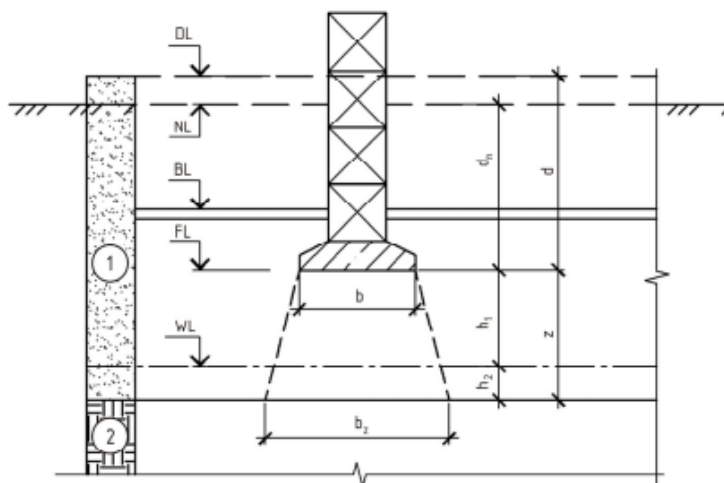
Расчетная схема для проверки подстилающего слоя грунта
